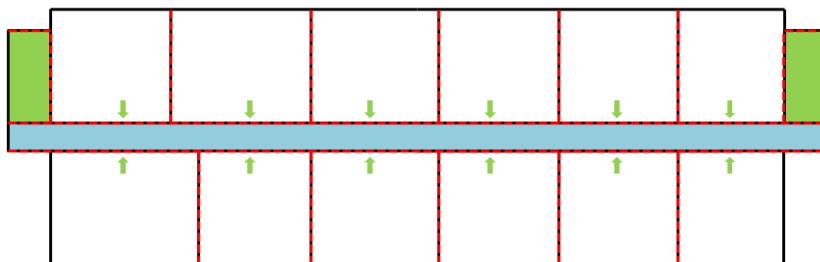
Planskisse for boligblokk med ett trykksatt trapperom type Tr3
